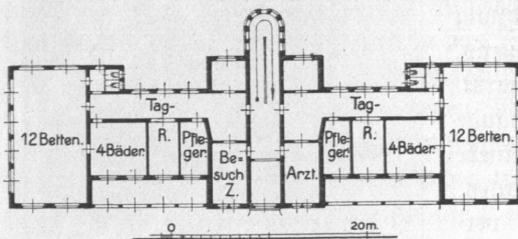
Irrenanstalt Friedrichsberg, Krankengebäude, Erdgeschoss, Grundriß.
